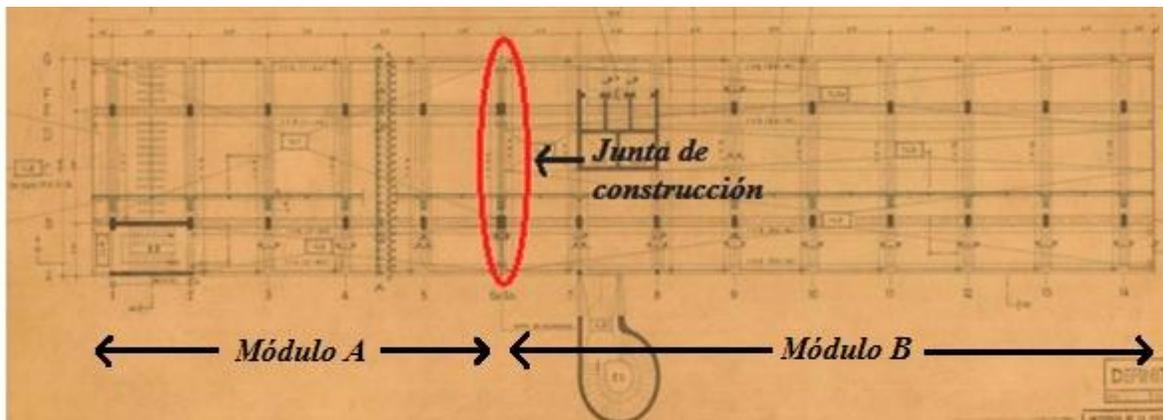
Ubicación en Planta de la Junta de Construcción.
